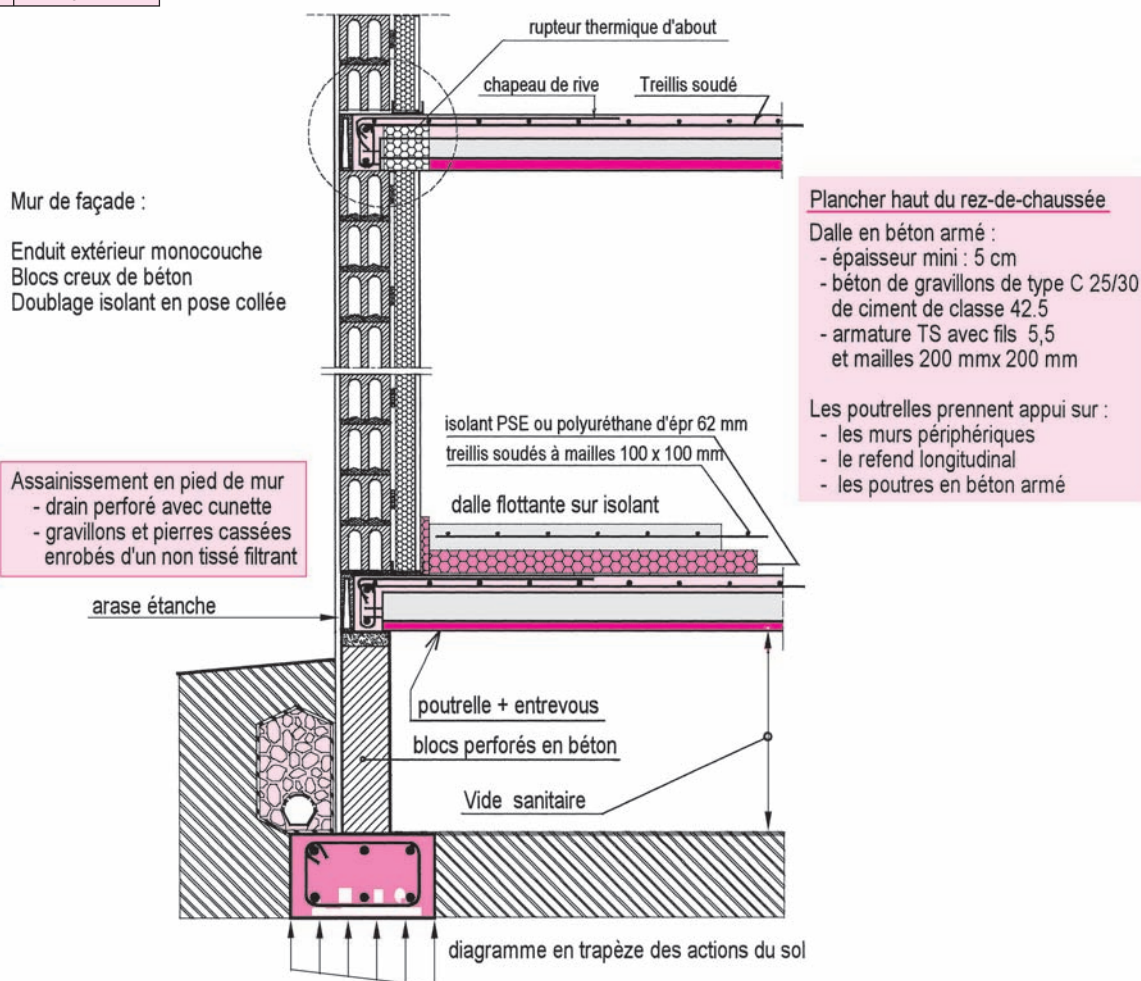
Détail de soubassement et de plancher bas sur vide sanitaire
